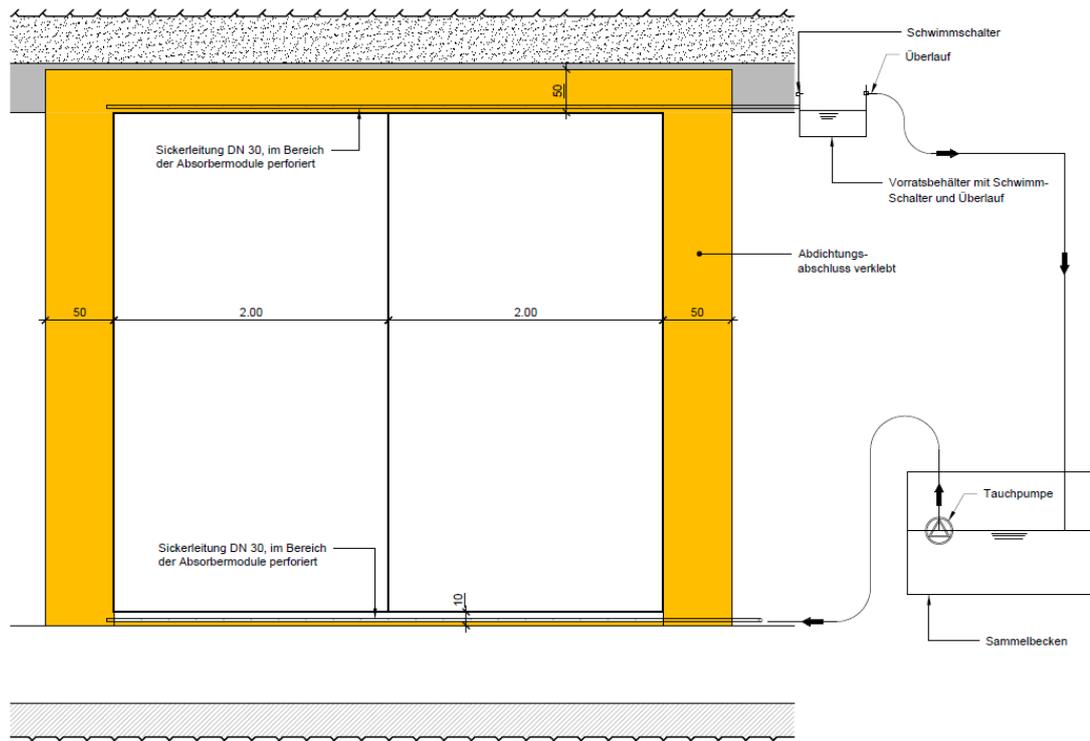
Längsschnitt Bewässerungssystem [Auszug aus Plan Anhang A1]
